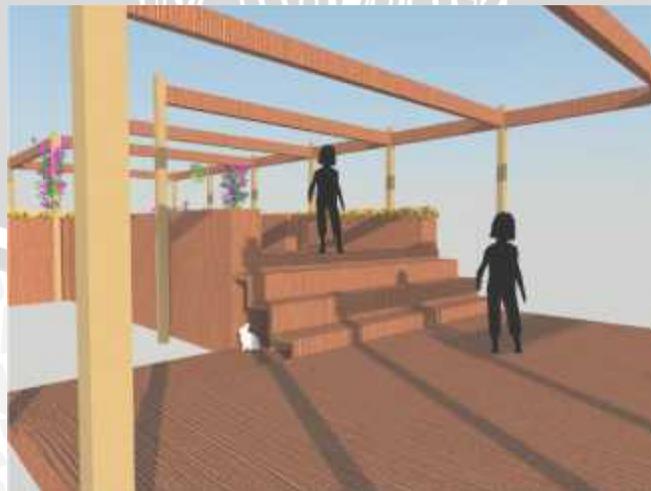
Rekomendasi Alternatif Perubahan Ruang Mati 3
